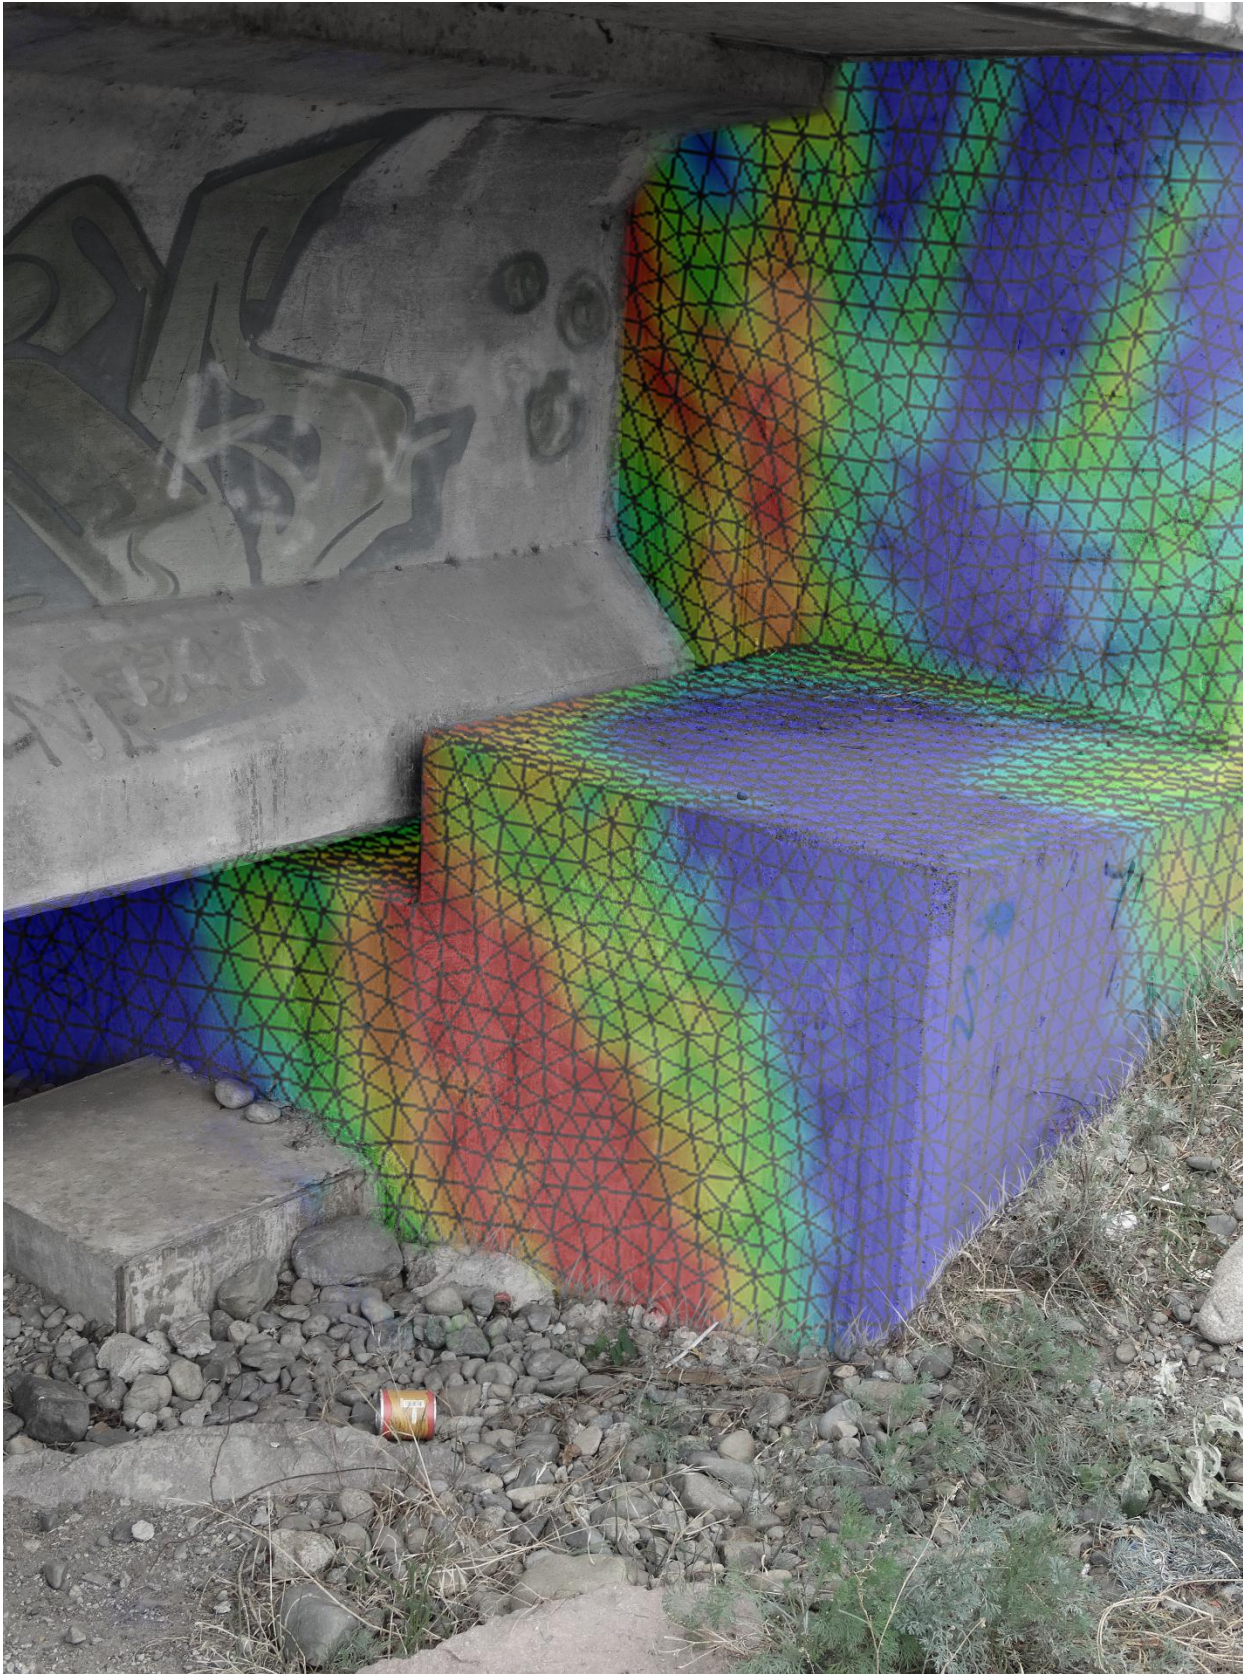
Comparación Deformaciones Plásticas de Hormigón versus Foto de Estribo Puente Águila Norte (Estribo 2 Llave Sur).
